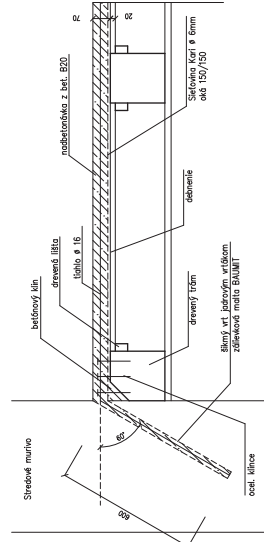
Stuzujúce tiahlo T s roznášacou platňou
